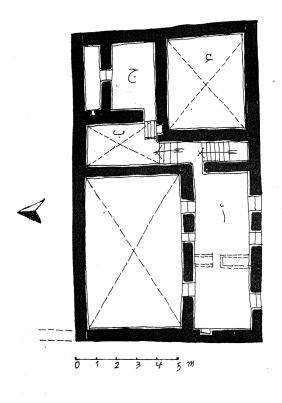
٪ منزل ابو همام الدور الأرضى المستوى الأول – مسقط أفقى
